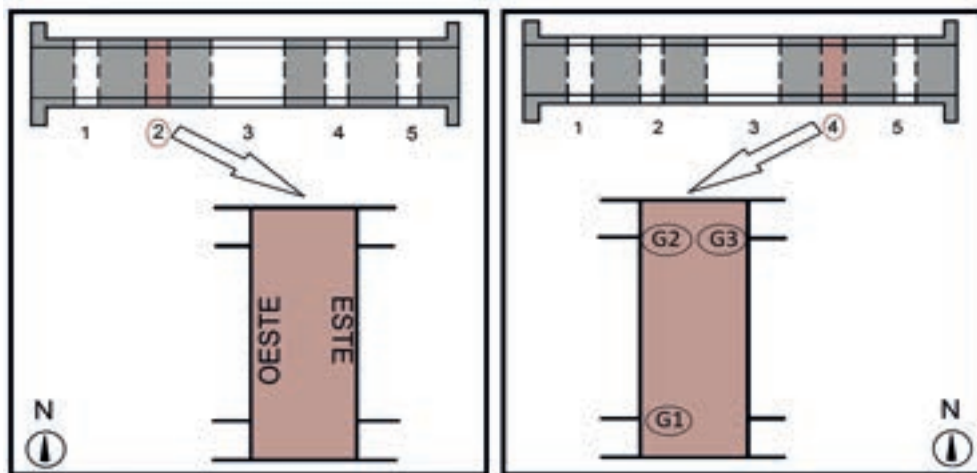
Planta del puente y croquis de los aliviaderos 2 y 4. Puente del Salero
